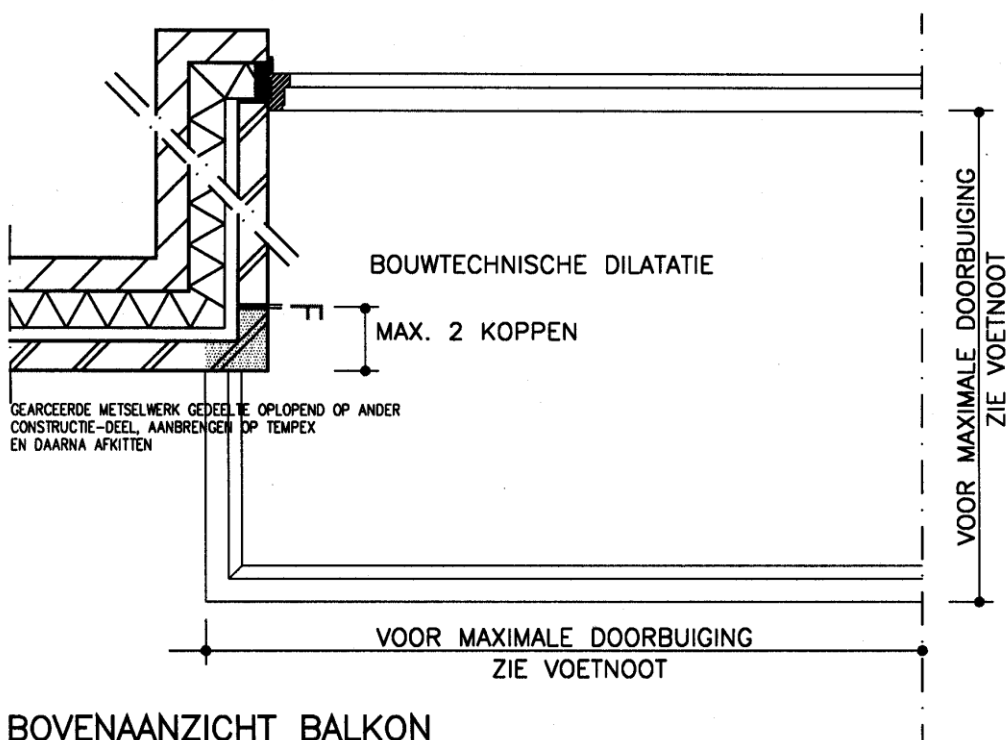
Uitkragende prefab beton balkon dilatatie aan de balkonzijde
